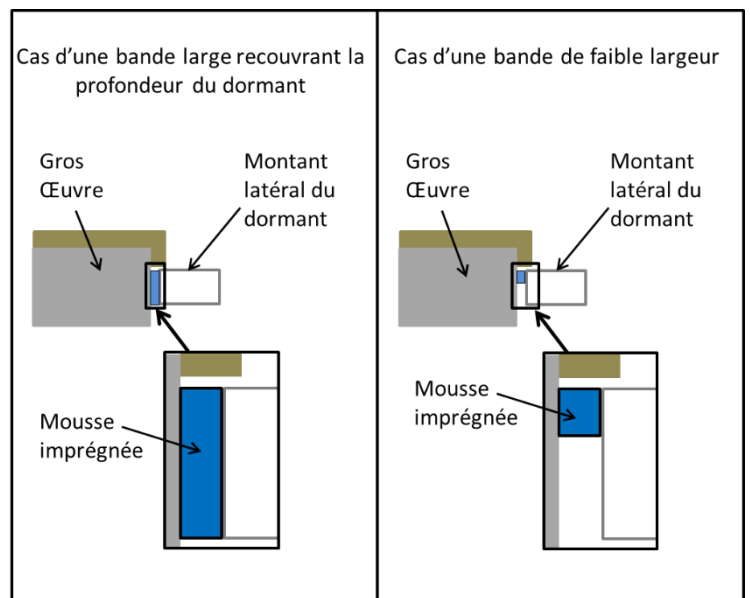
illustrations de calfeutrement latéral par mousse imprégnée : cas de bandes de grande et faible largeur
